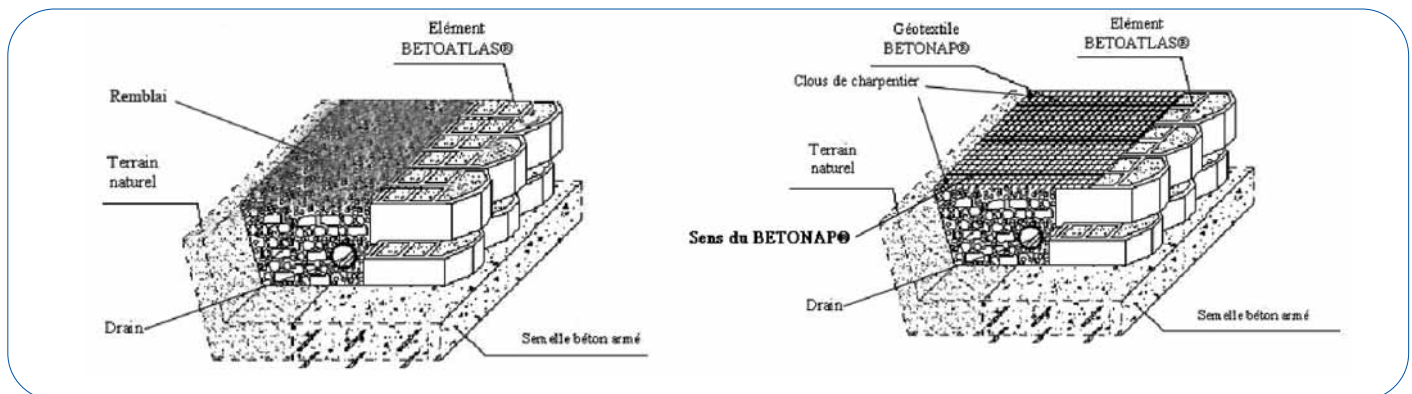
Schéma général d'un mur de soutènement fait de blocs préfabriqués
